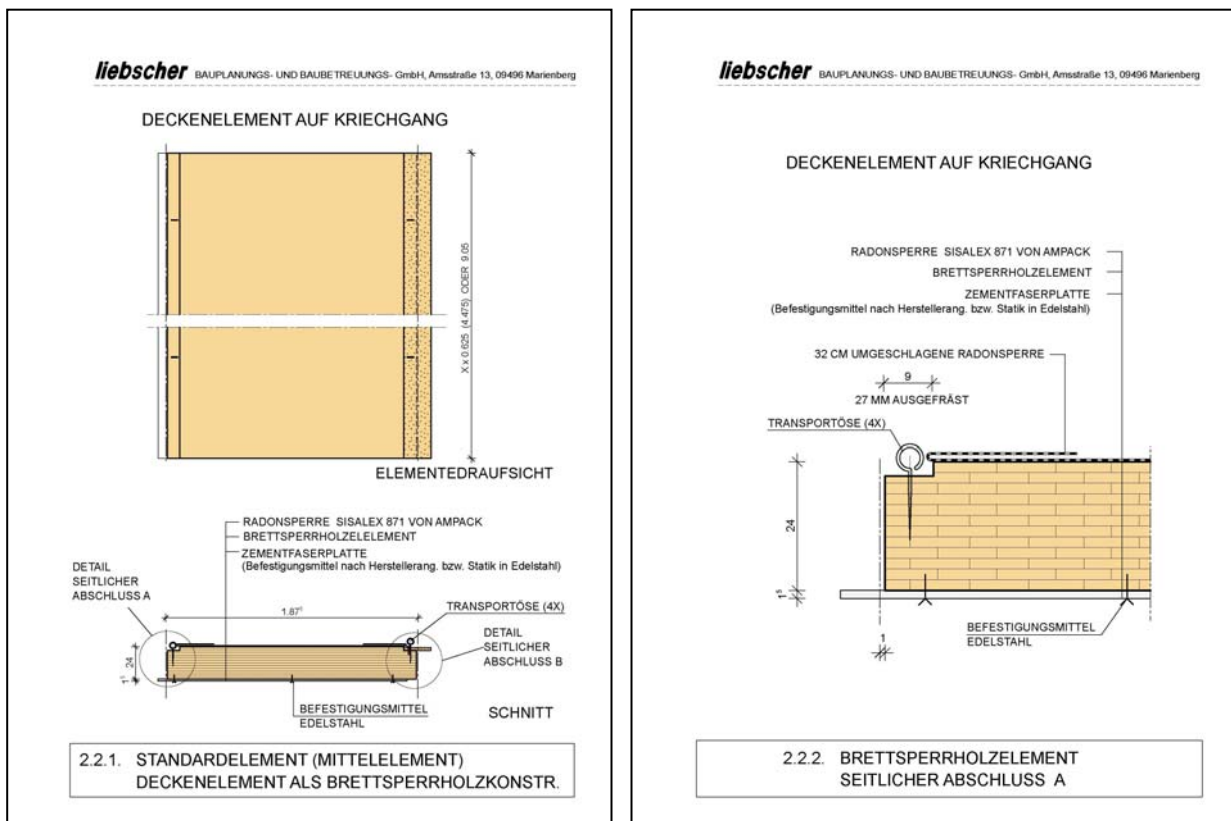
Standardelement, Deckenelement als Brettsperrholzkonstruktion
